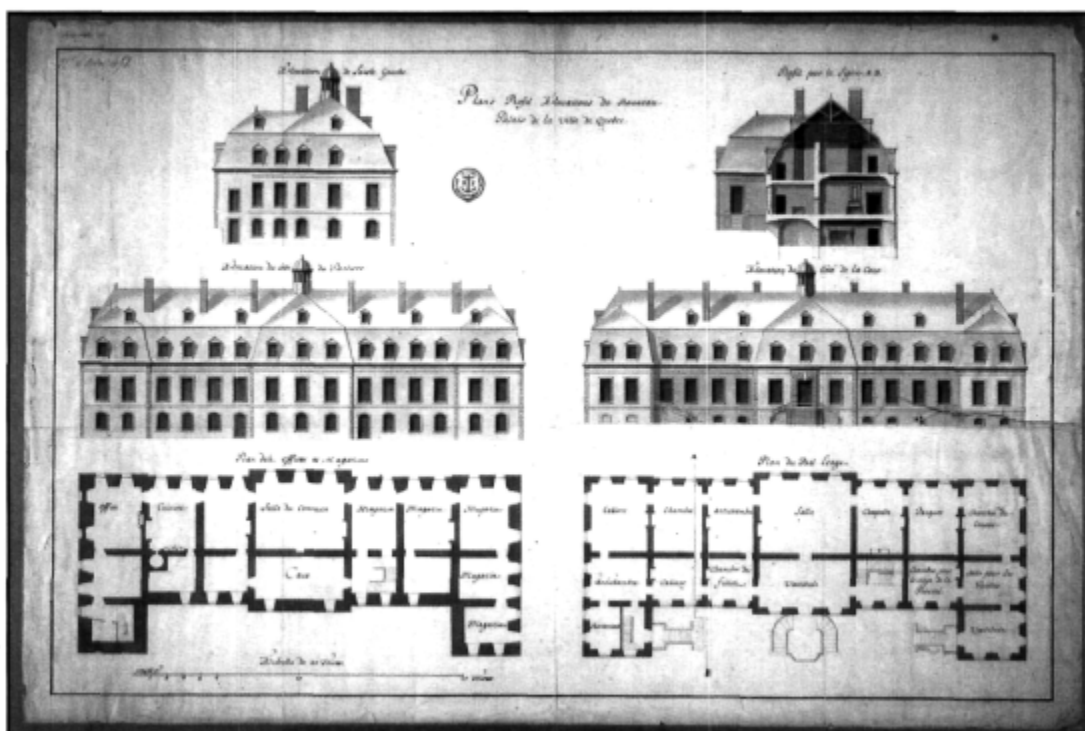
Plans, profils et élévations du nouveau Palais de la ville de Québec. S.d. Centre des archives d'outre-mer (France), 03DFC 451B
